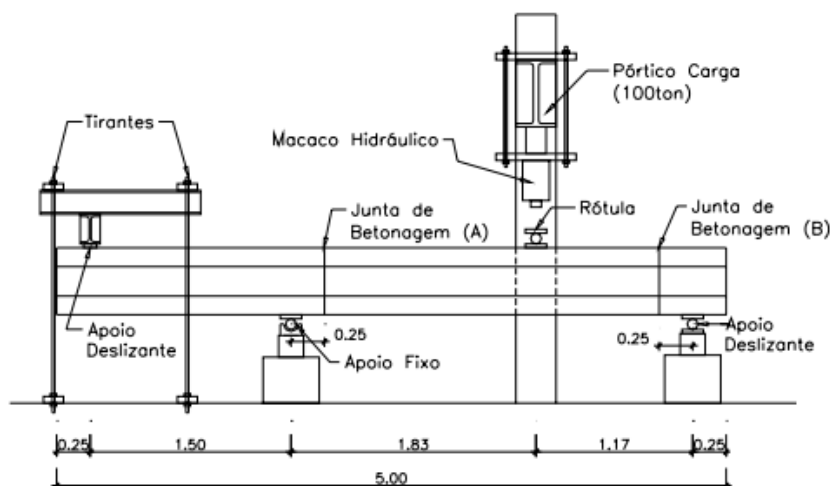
Dispositivo instrumental, retirado de Cavaco [27]
